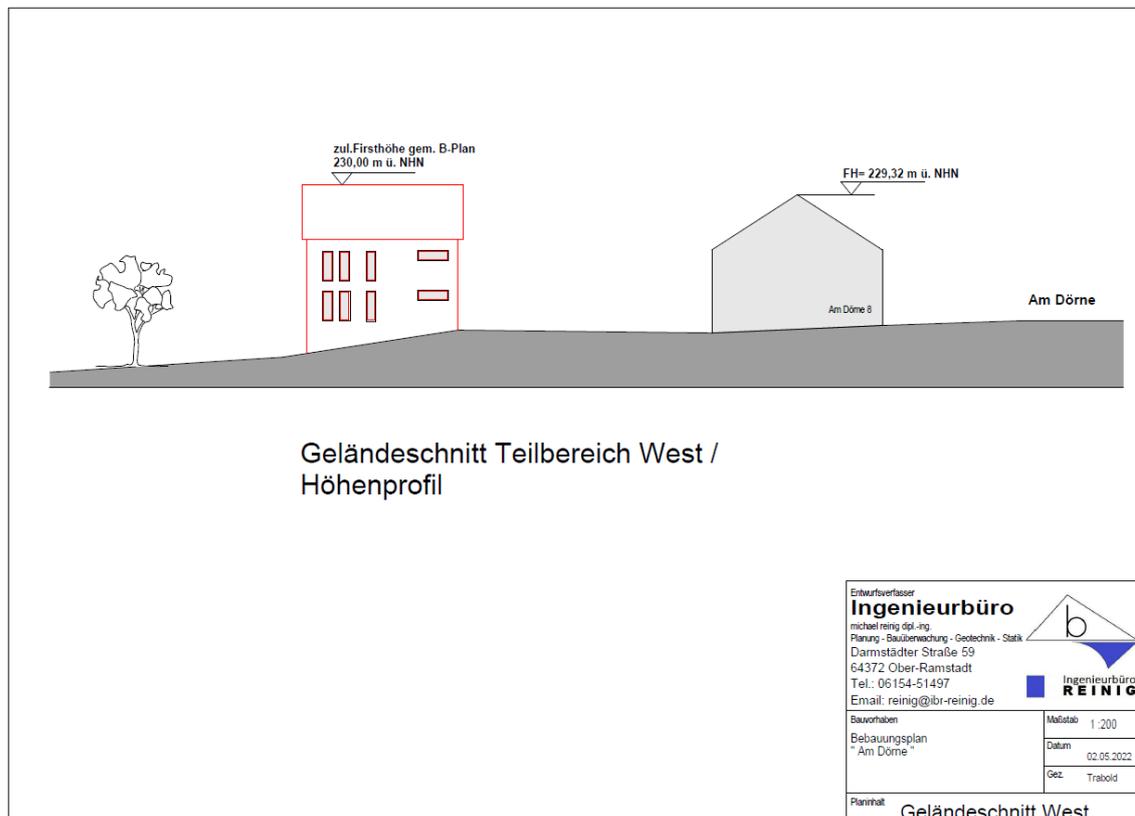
Geländeschnitt Teilbereich West / Höhenprofil, Ing. Büro Reing, 02.05.2022
